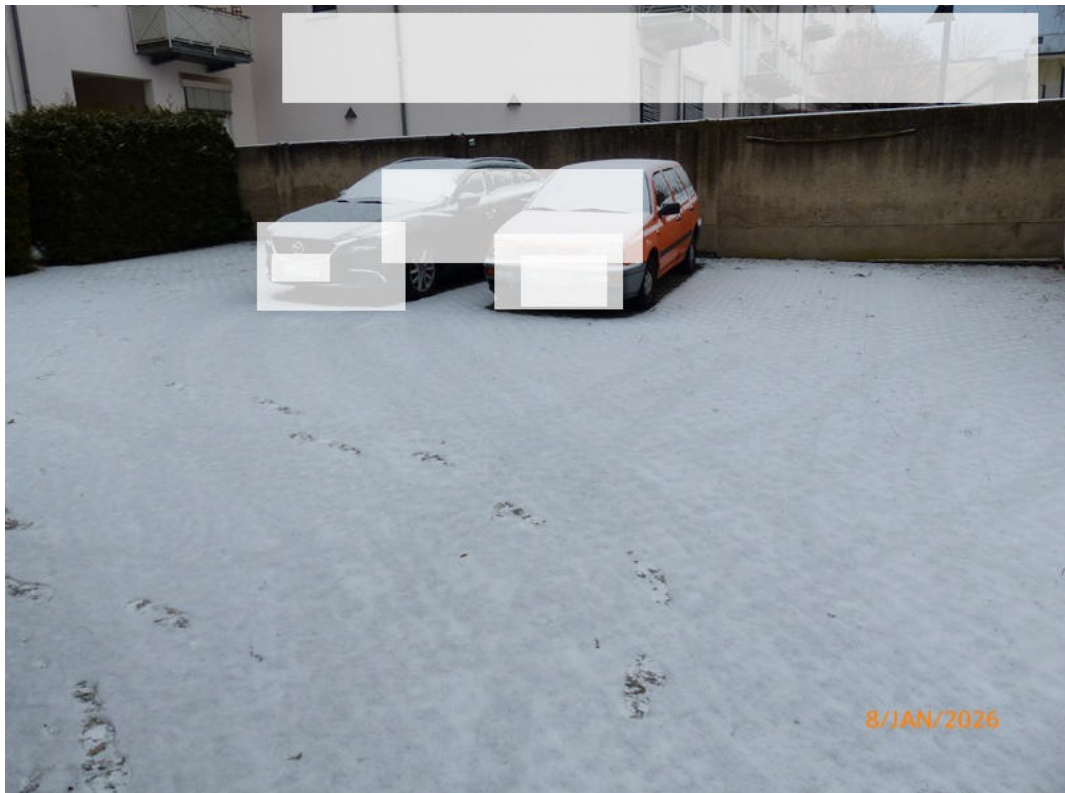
Hof der Wohnanlage – Blickrichtung Süden (GE)
